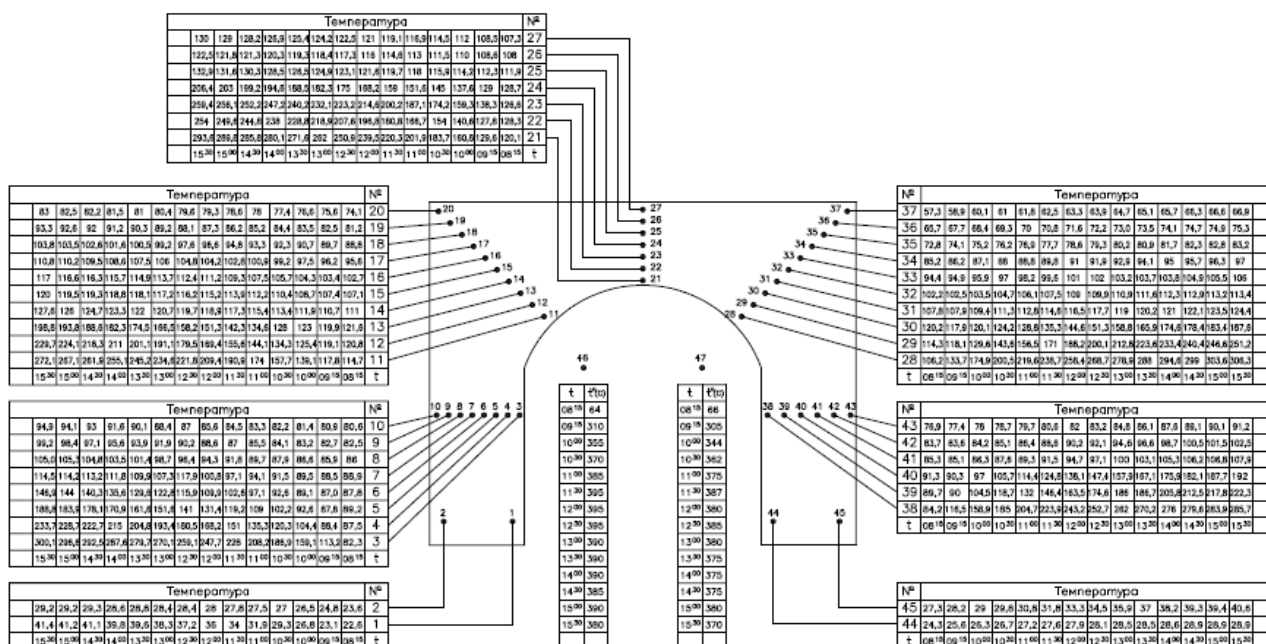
Схема расстановки термопар в железобетонном фрагменте фундамента №1 с футеровкой борова
